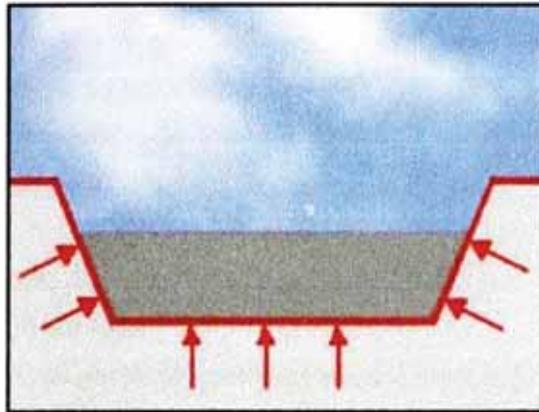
aplicación de las geomembranas en canales de Conducción.
